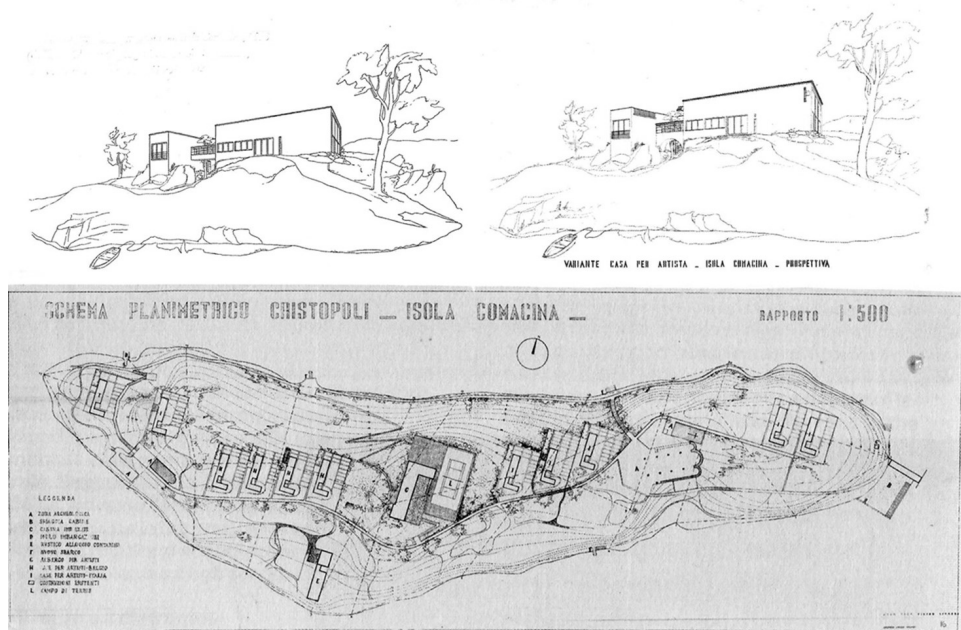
Planimetria del progetto Cristopoli (1933) e viste prospettive di due varianti della villa-atelier tipo. Archivio Lingeri.
